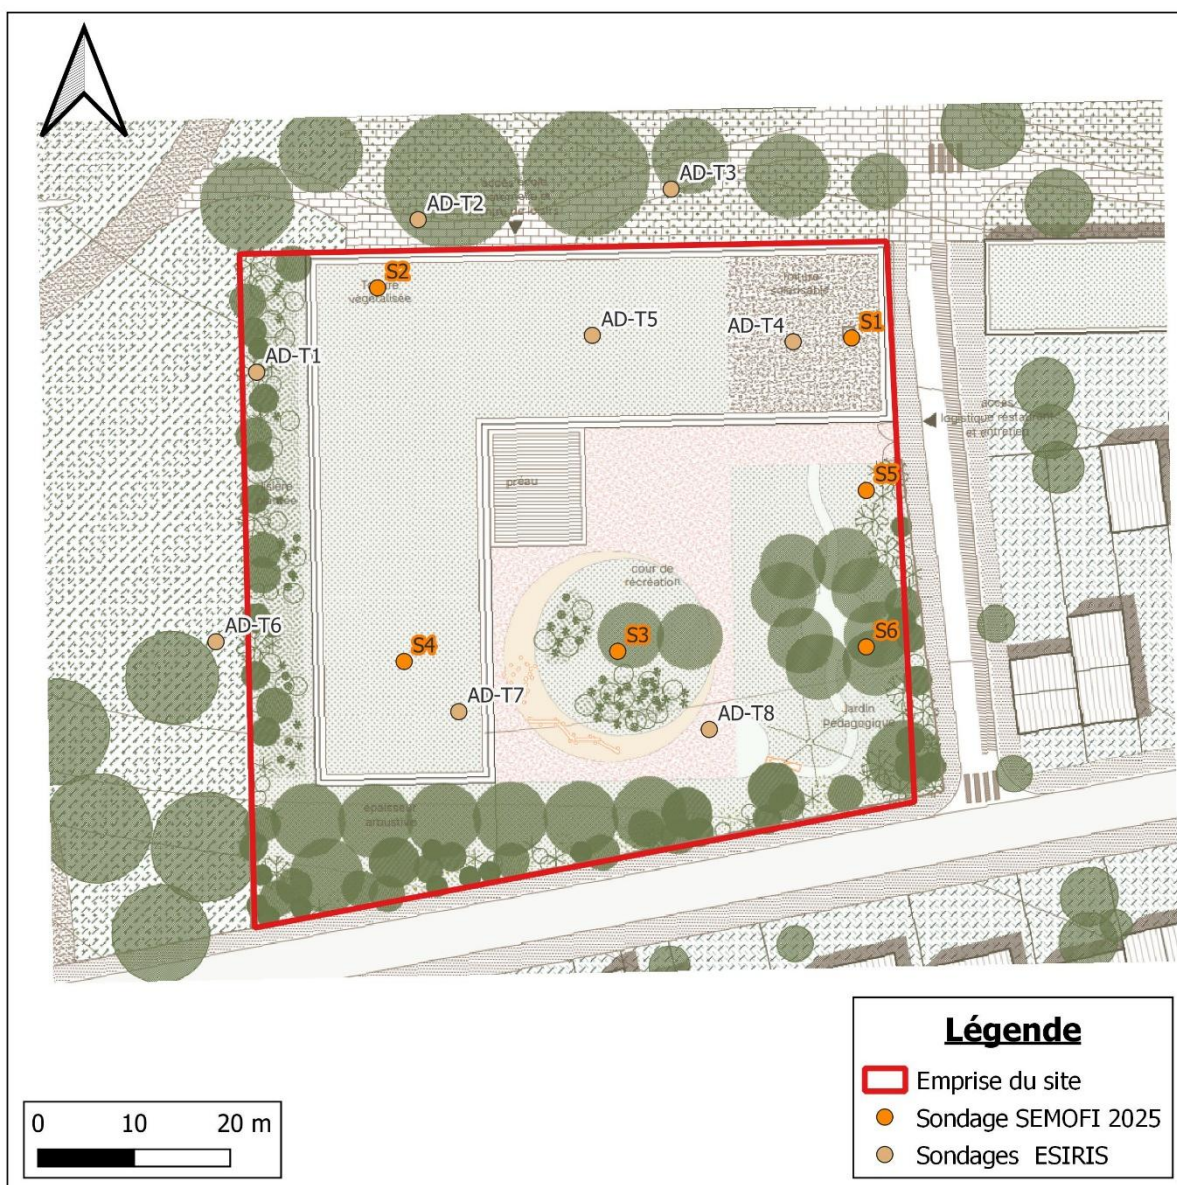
Plan d'implantation des sondages réalisés par rapport au projet
